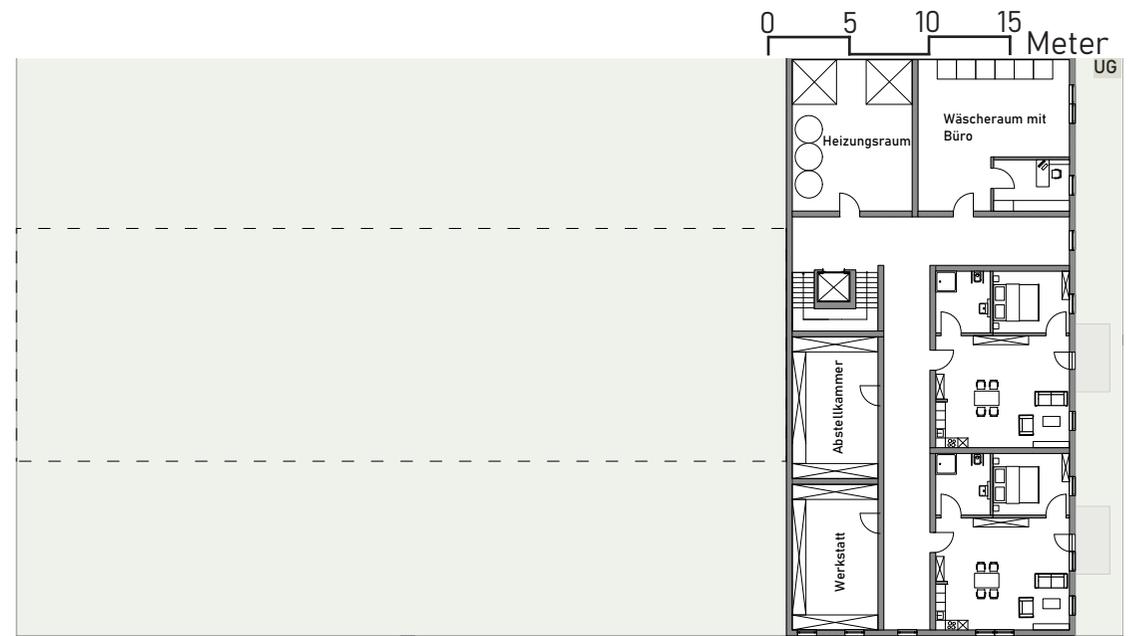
Grundriss UG (V1 Stelzenbau)
